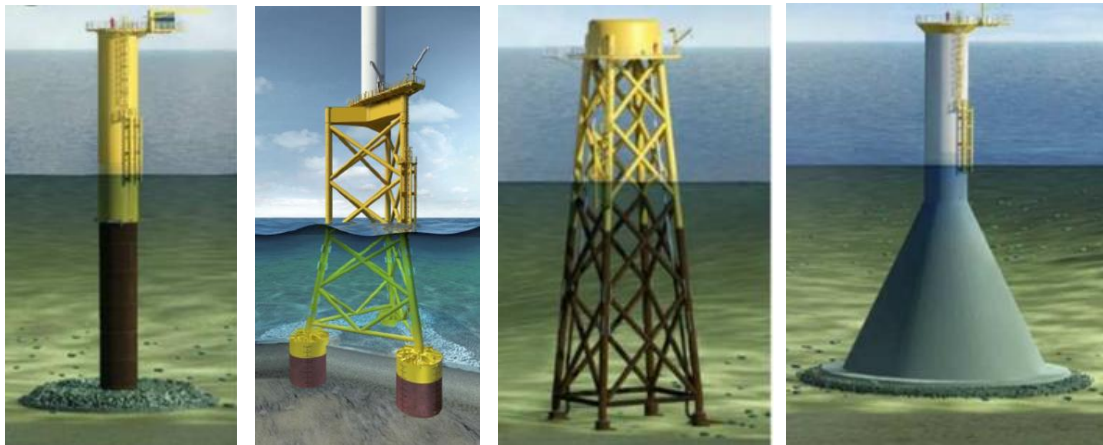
Types de fondations éoliennes en mer posées sur le fond marin (de gauche à droite : monopieu, jacket avec ancre à succion, jacket à pieux, fondations gravitaires) [Dührkop et al., 2016 ; Sparrevik, 2019]
